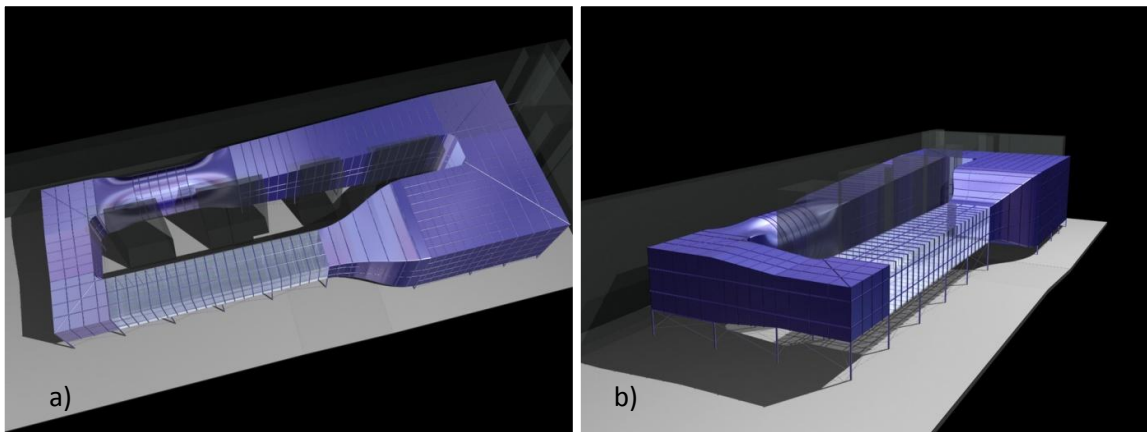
1: Schema dell'impianto vista dall'alto a) e vista di lato b)
